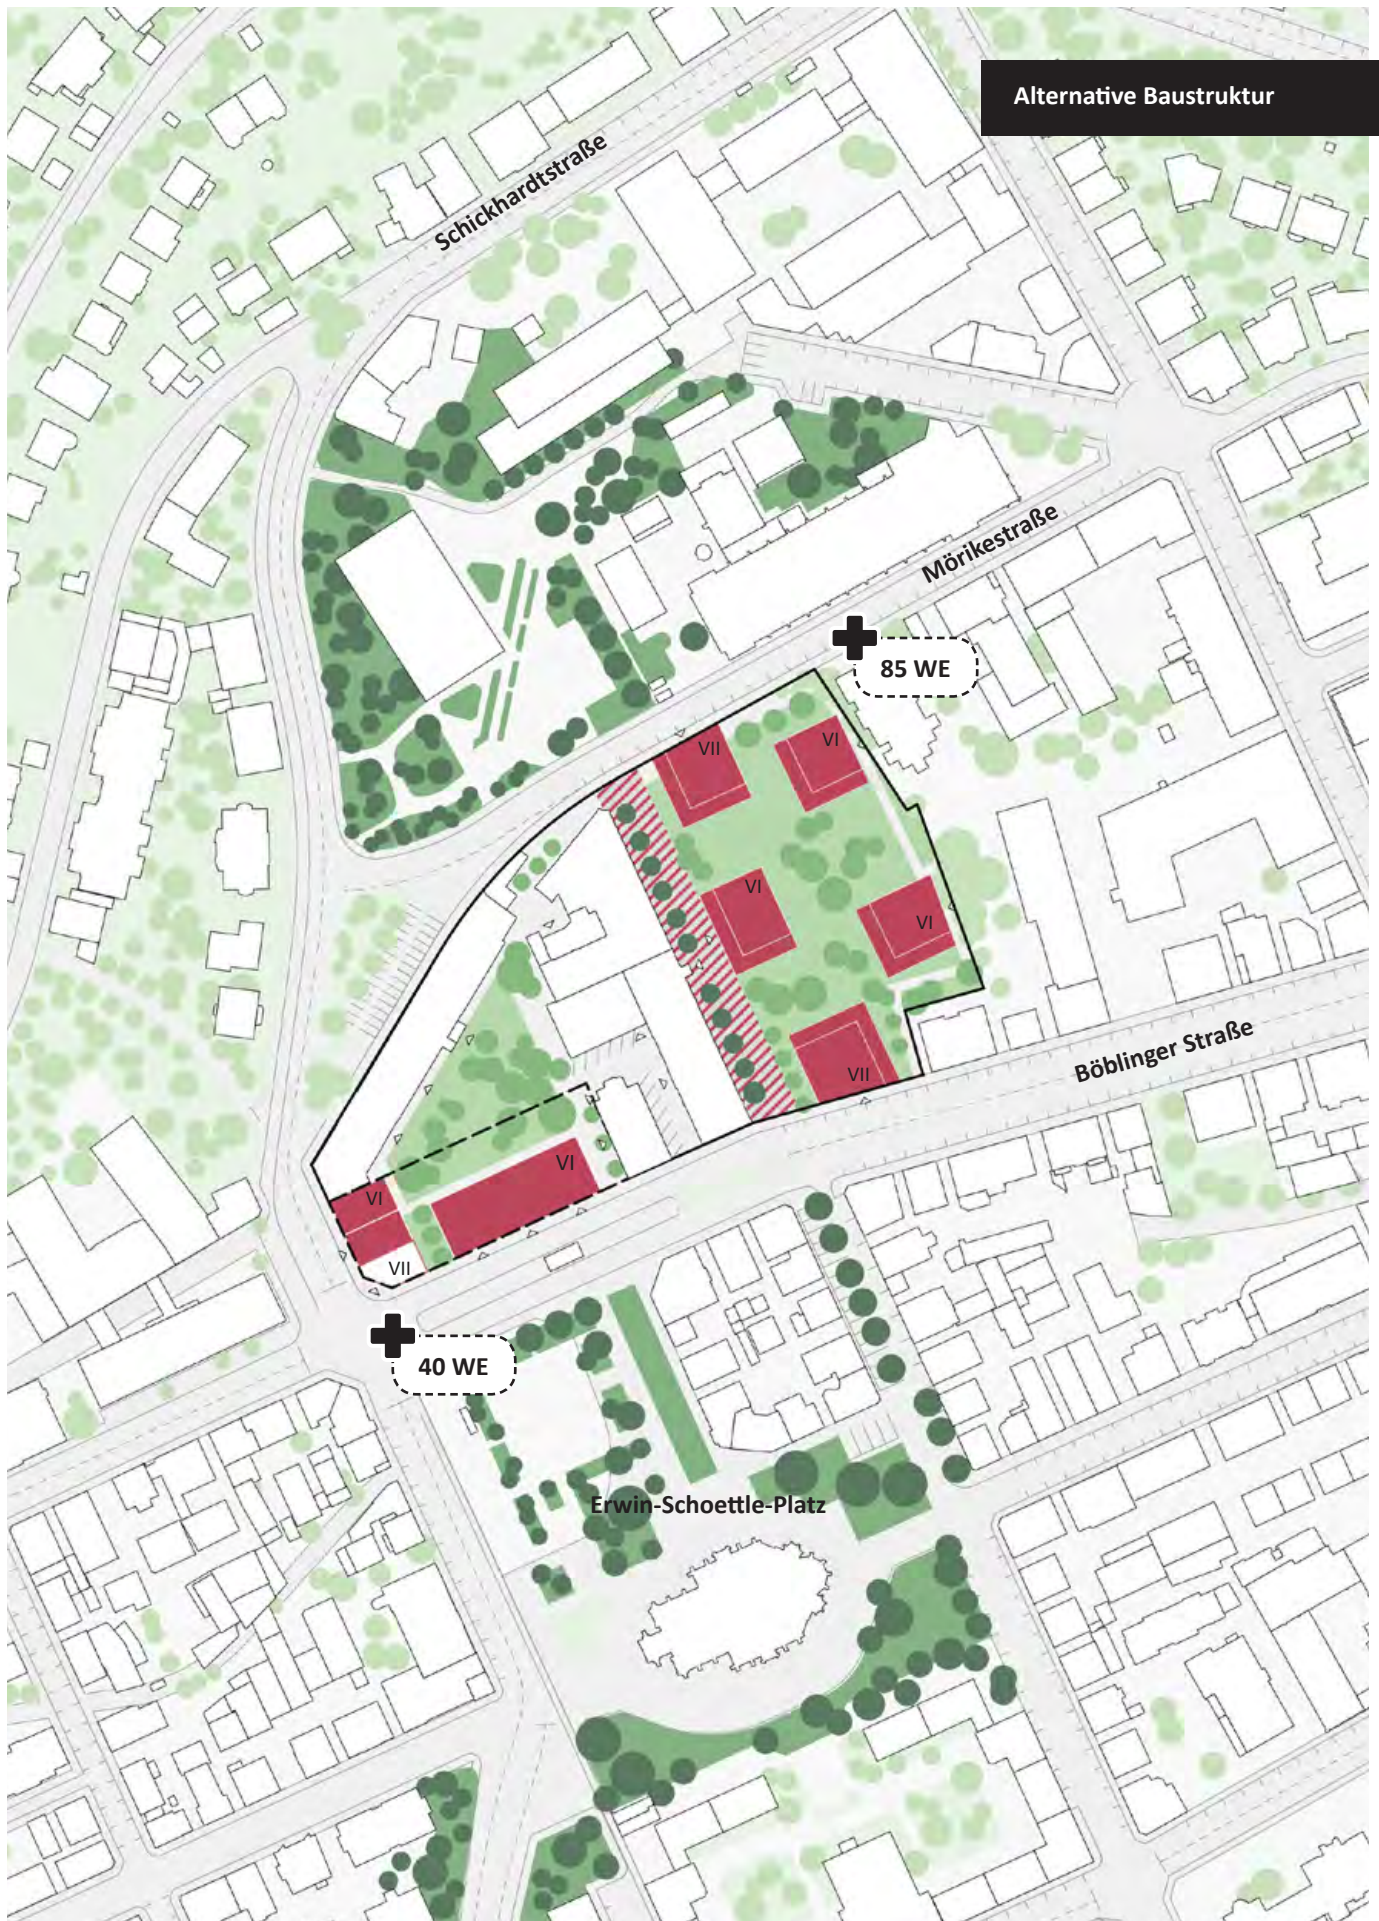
Lageplan der alternativen Bebauungsstruktur
